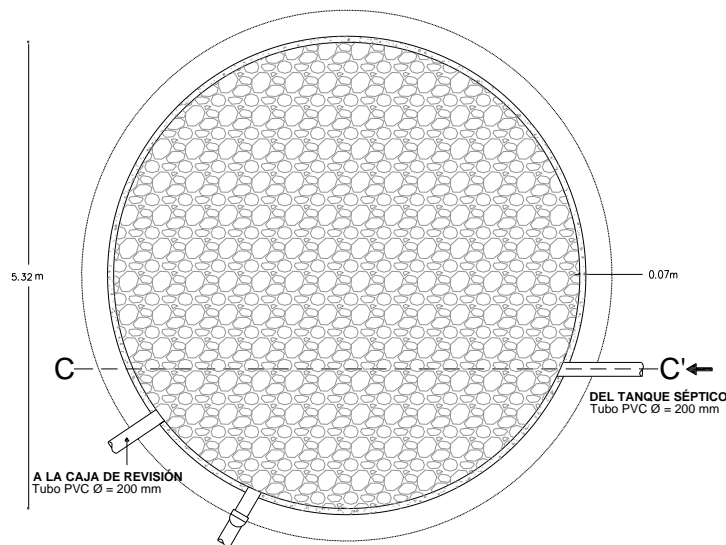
Vista en planta del filtro anaerobio de flujo ascendente
